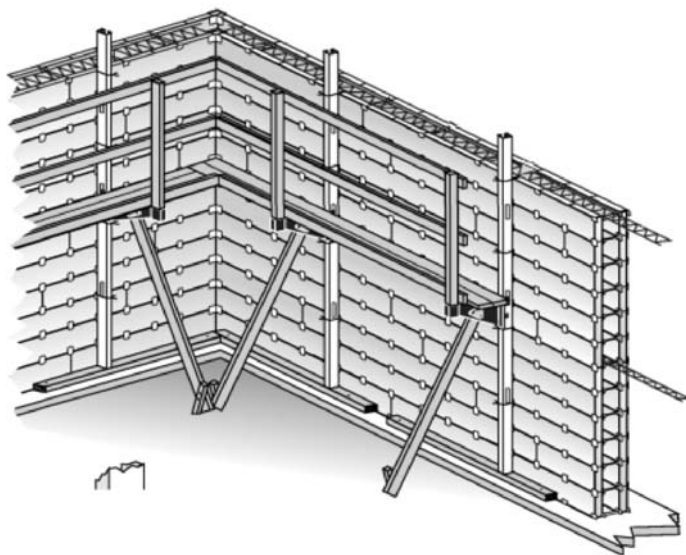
Установленные опалубки и арматуры 1-го и 2-го яруса бетонирования (дополнительные стойки и прогоны не показаны)
